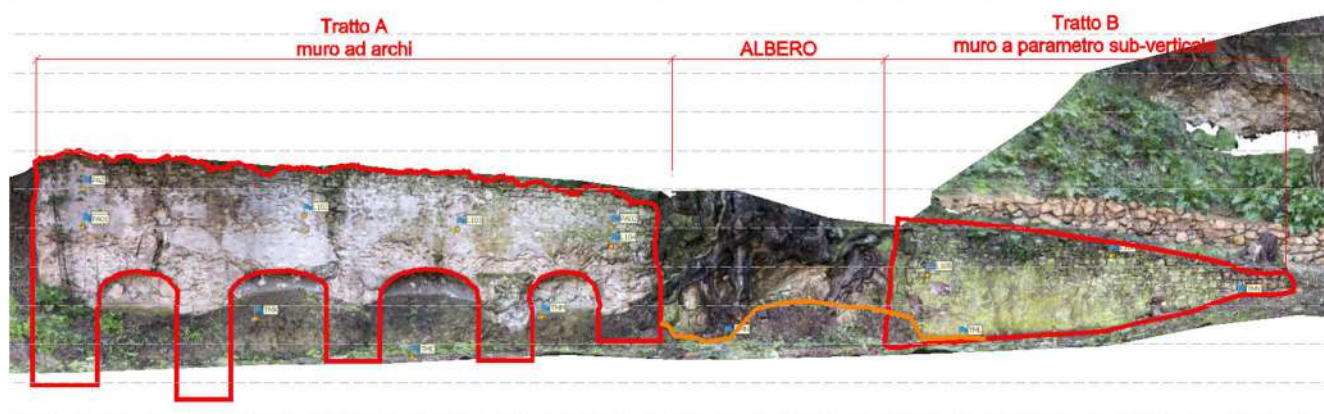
Prospetto del muro (da laserscan) ed individuazione dei tratti principali
